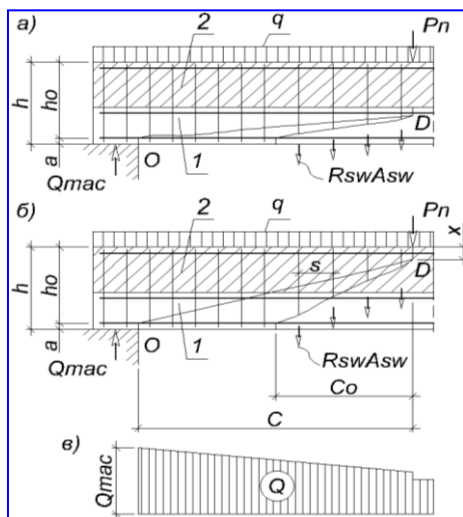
Расчетная схема по наклонным сечениям пояса: по рабочей высоте сборного (а) и сборно-монолитного (б) элемента; эпюра поперечных сил (в); 1-сборный элемент; 2- монолитный бетон [рис. автора].
